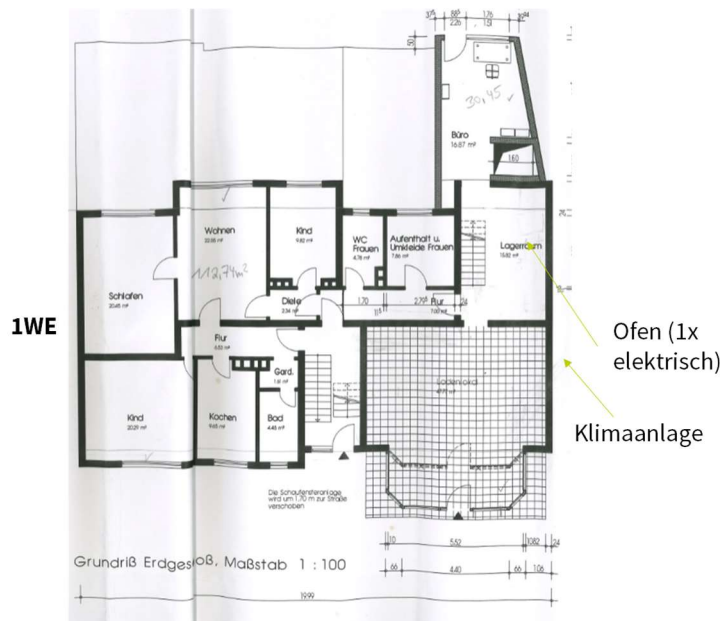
Grundriss des Erdgeschosses mit Verkaufsraum und einer Mietwohnung
